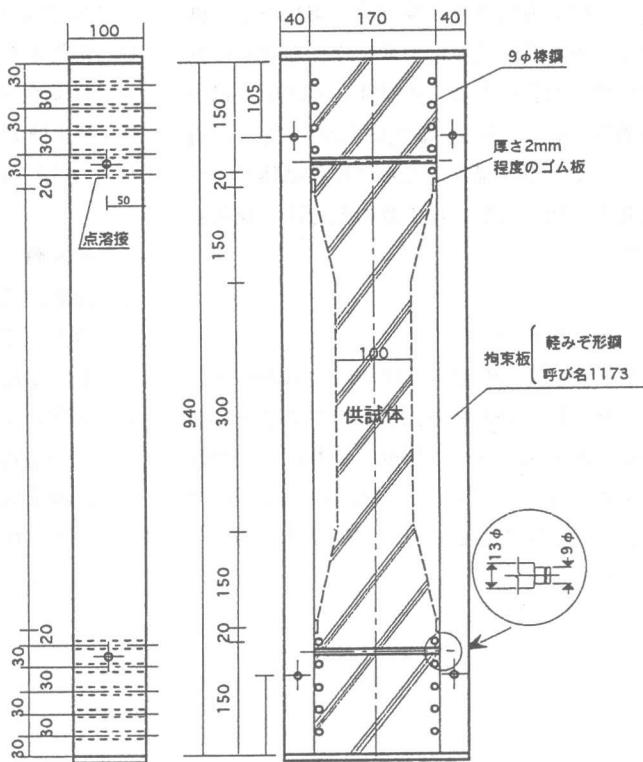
乾燥収縮ひび割れ拘束器具および供試体
